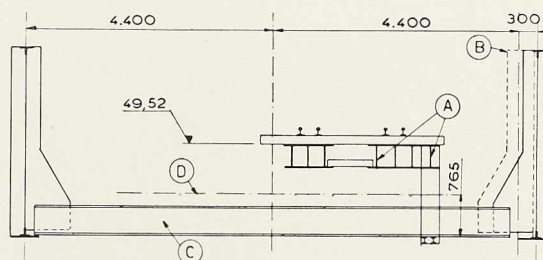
Mise en place des entretoises et ripage de la poutre côté Soissons :
